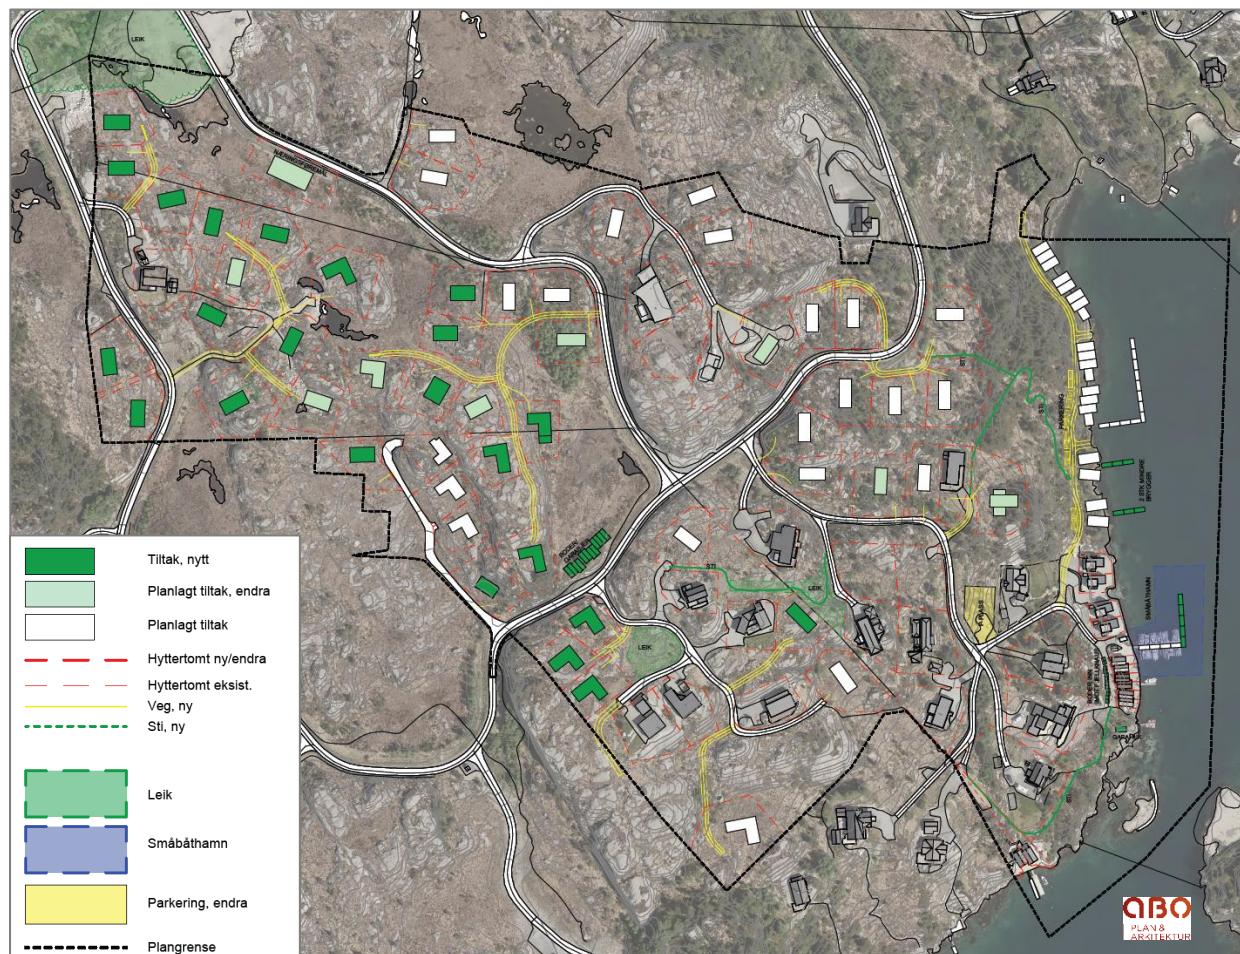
Forslag til plangrense er vist med svart stipla linje.
